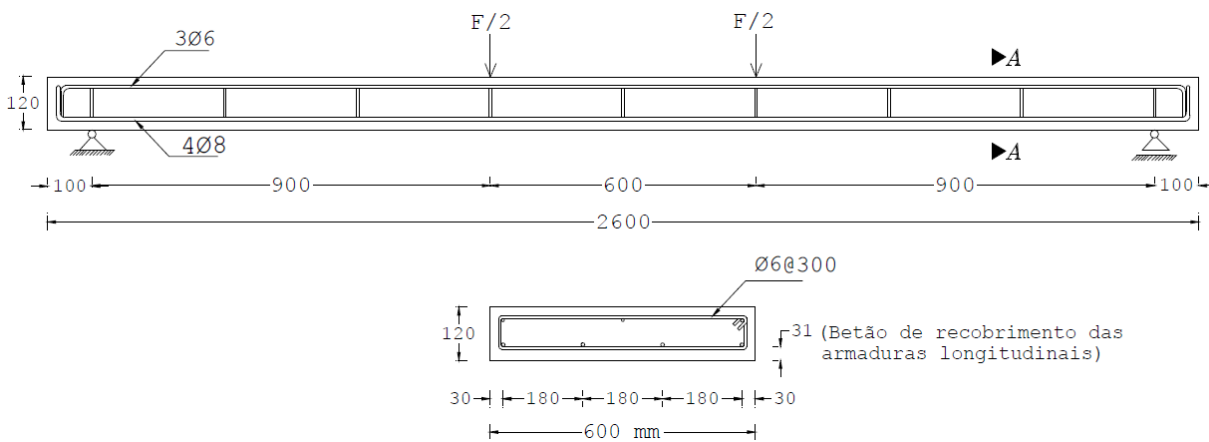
Geometria e armaduras das lajes ensaiadas e tipo de ensaio (dimensões em mm).
